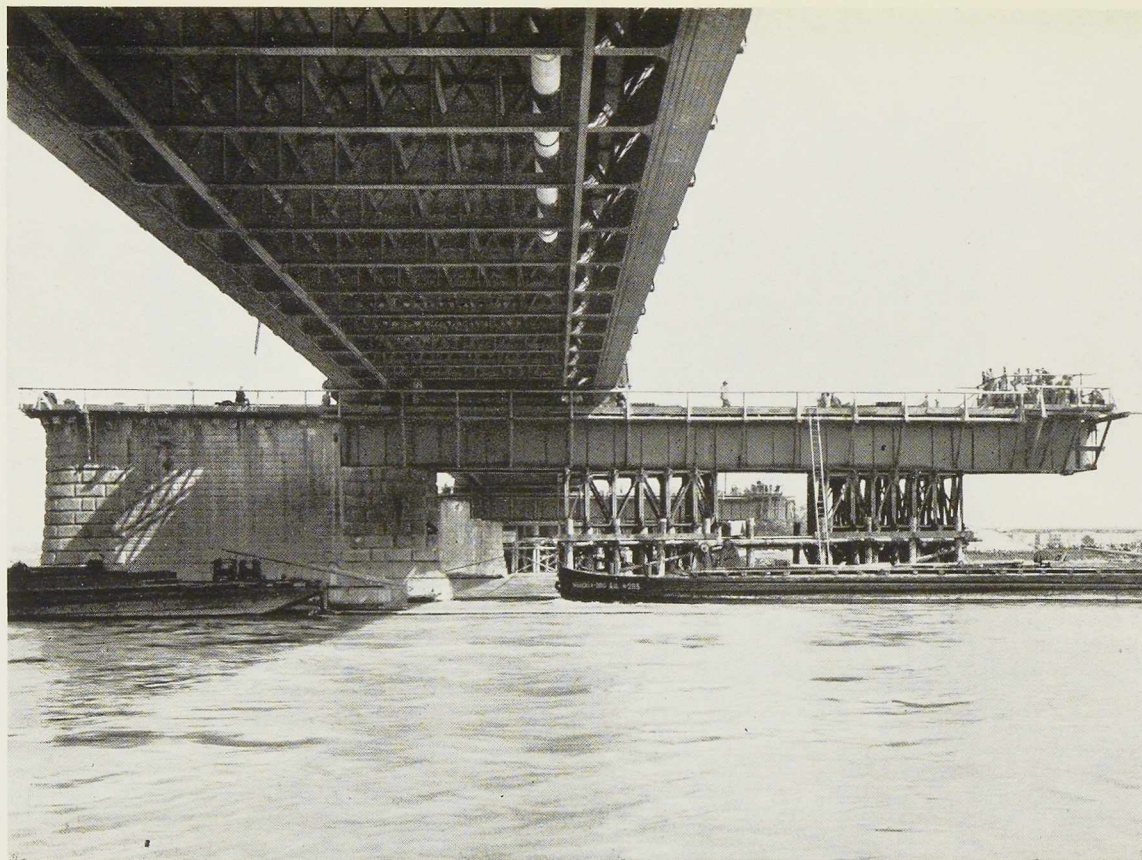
Le pont vient de quitter les piles en maçonnerie et s'est engagé sur les poutres en acier. Pendant la durée des travaux il reposera sur ces poutres au droit des piles constituées par des pieux en bois.
